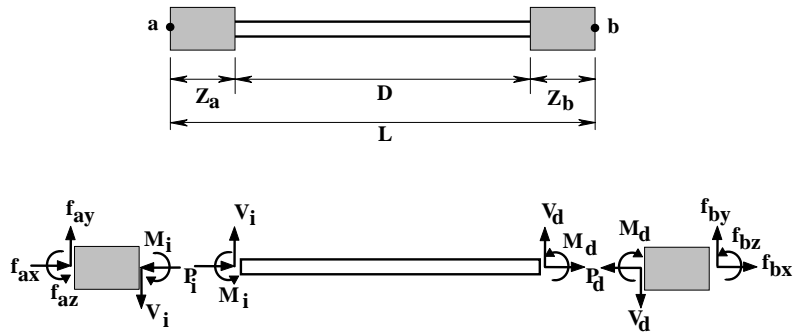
Elemento con zonas rígidas en coordenadas locales
